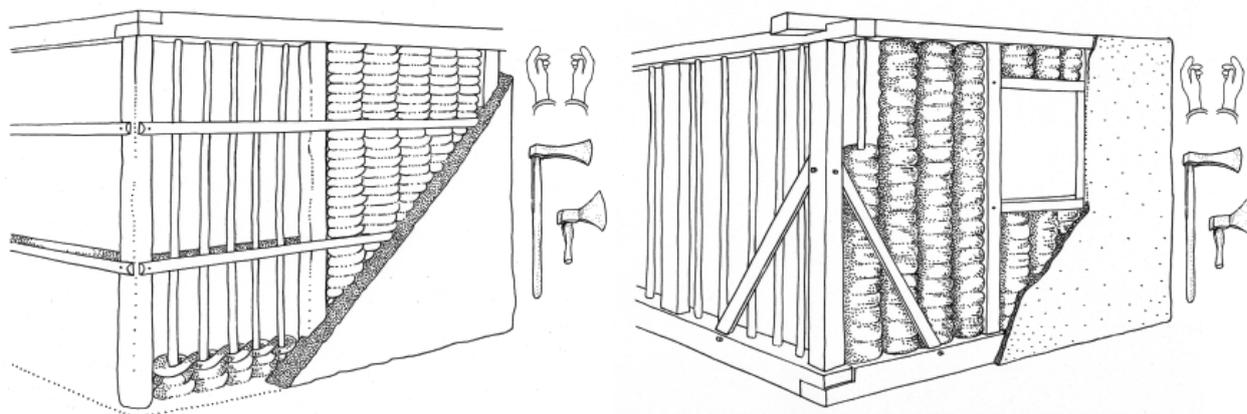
Ejemplos de técnicas constructivas con entramado permanente de madera (García, Cristini, Tibor)
